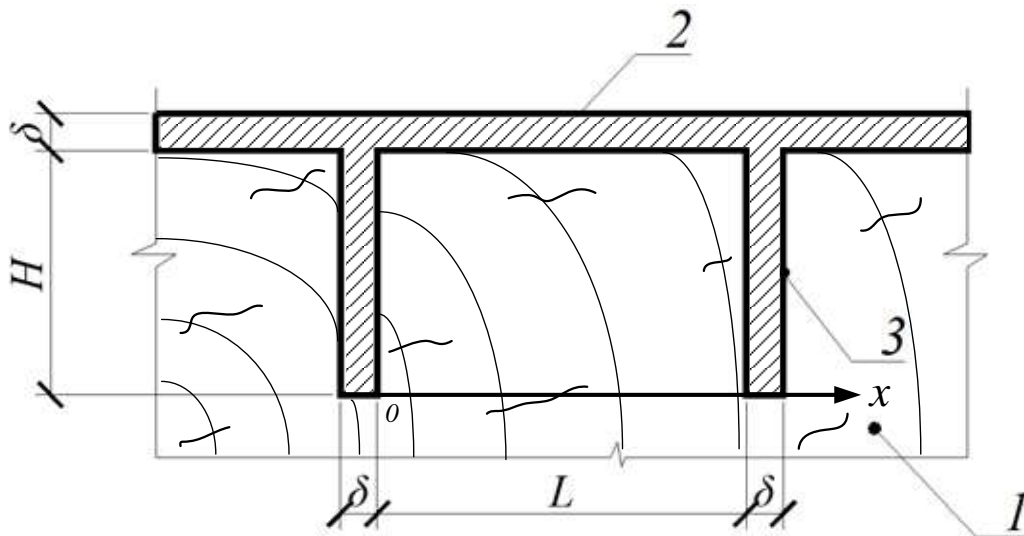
Модель металлической зубчатой пластины (МЗП) с двумя зубьями: 1 – древесина; 2 – пластина; 3 – зубья; L – расстояние между поверхностями соседних зубьев; H – длина зубьев; δ – толщина МЗП
